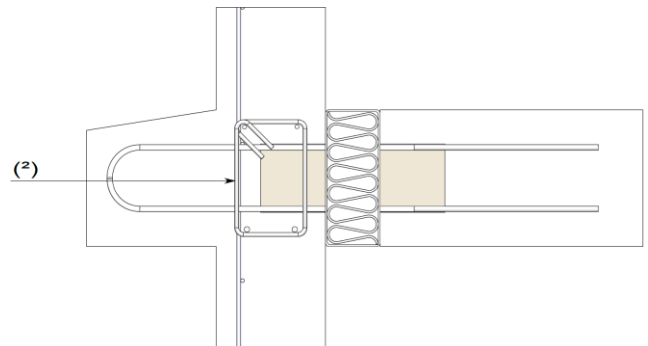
Chainage de mur – liaison dalle – casquette - disposition 2 (vue en coupe)
